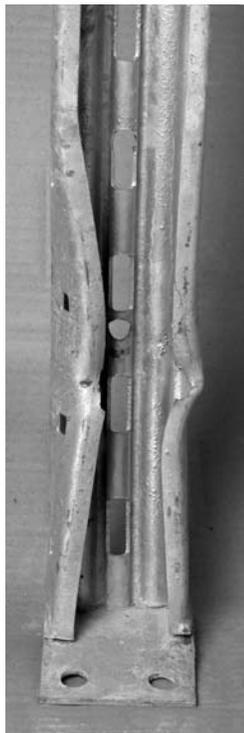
Montant en acier galvanisé endommagé par des impacts à l'arrière (Vue de l'arrière)
